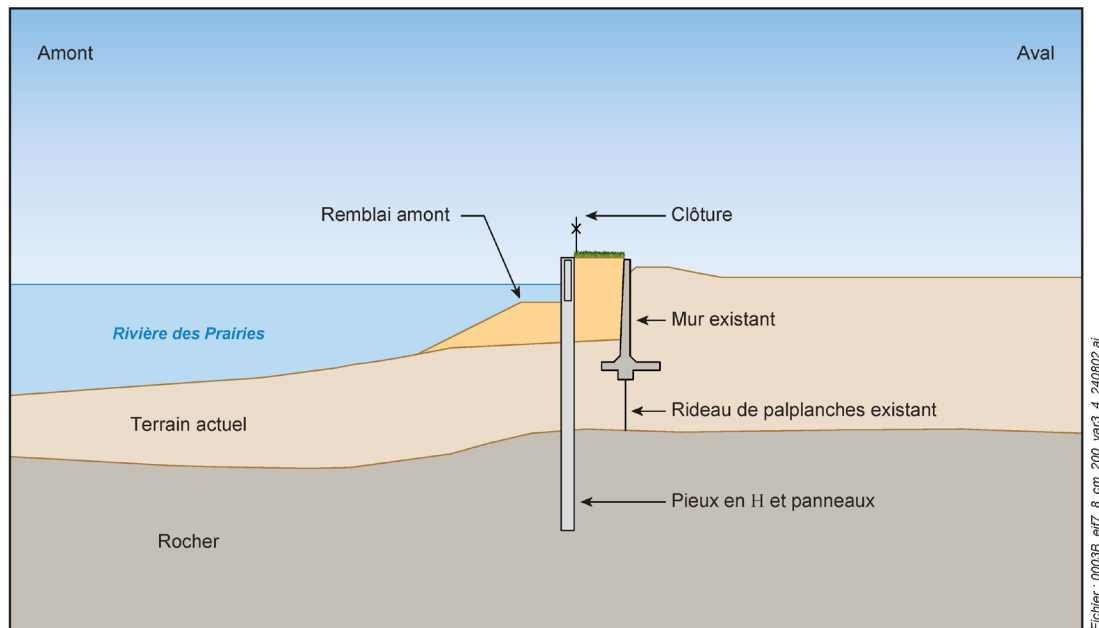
Paroi verticale en panneaux préfabriqués avec remblai amont
